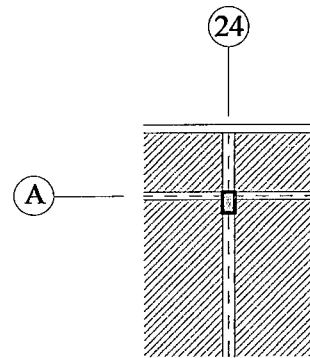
Proyecto [Bloque 2: Sentido de losa aligerada]
